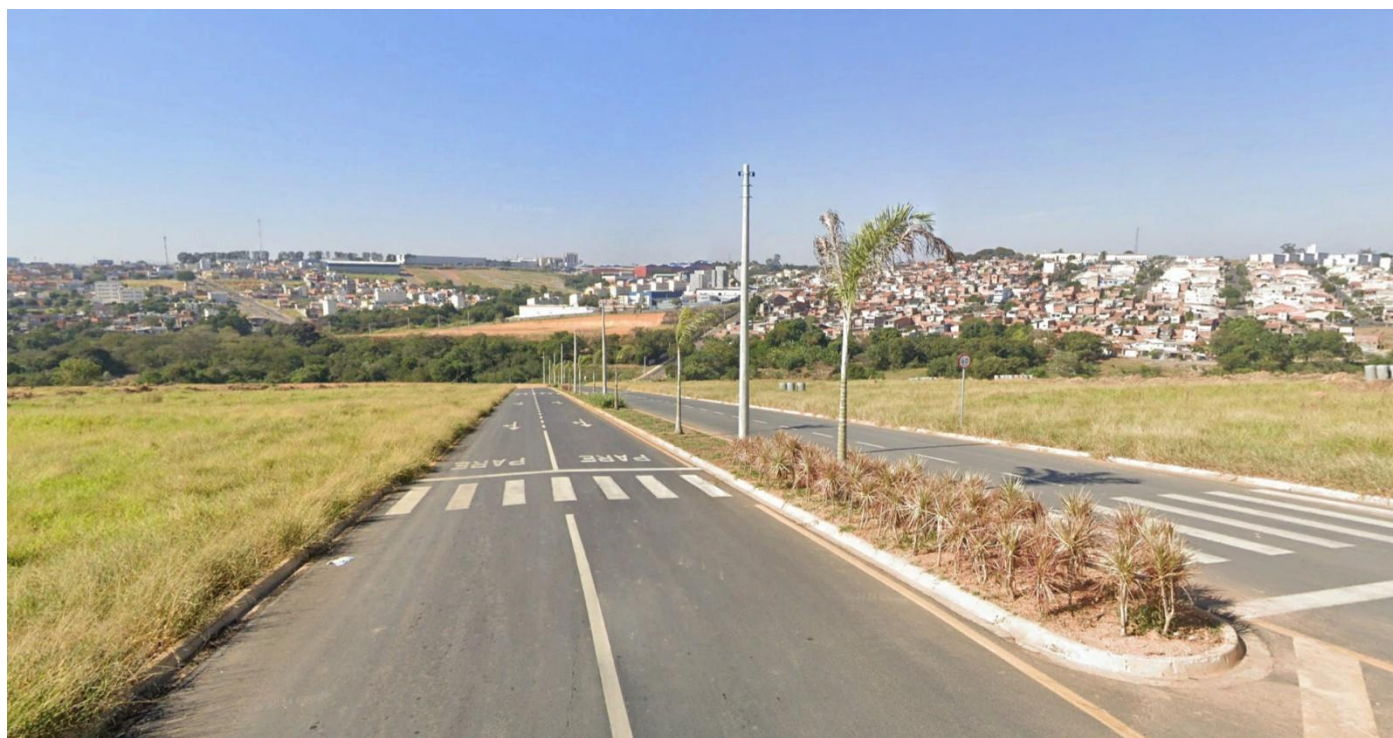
Infraestrutura – Avenida implantada no loteamento Jardim São Roque que interliga ao bairro, já consolidado, Parque Novo Mundo.
